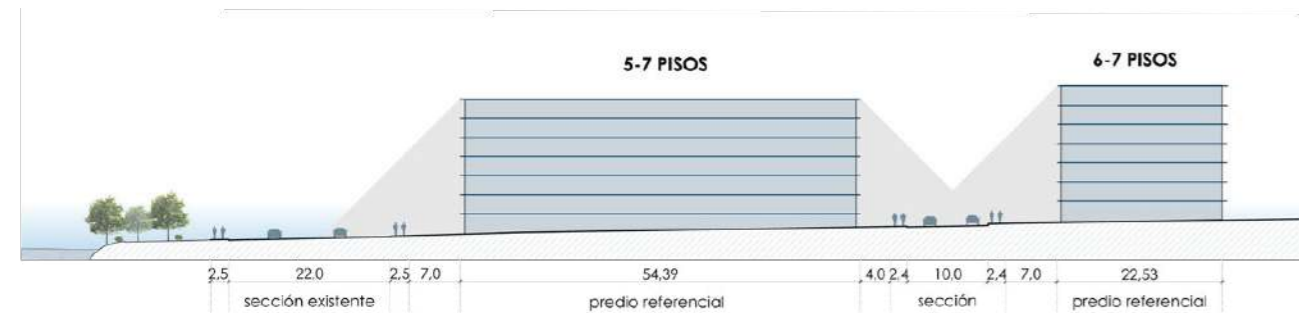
Sección 5-7 pisos. Fuente: Autoría propia (2026)
